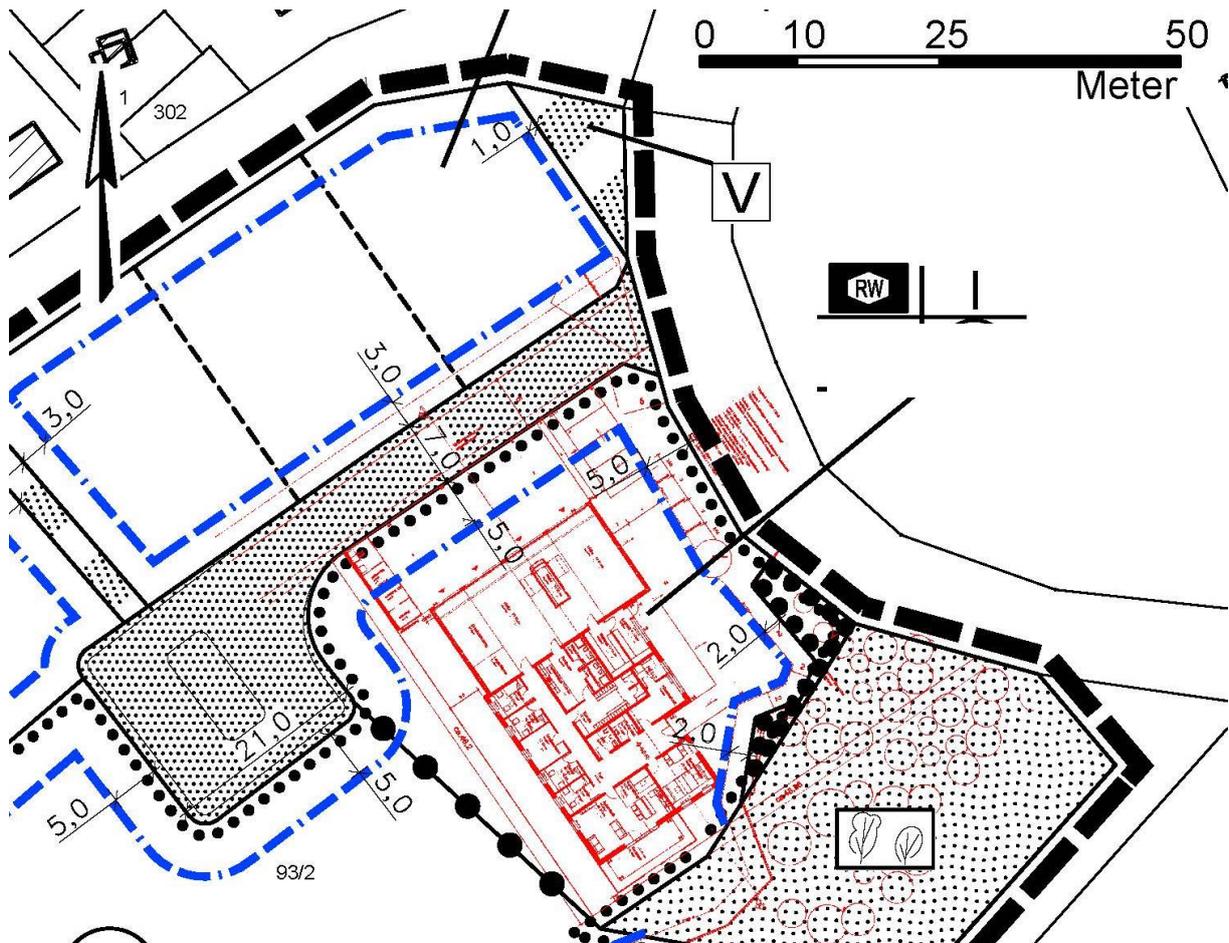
Überlagerung der Fachplanung der Rettungswache mit dem Bebauungsplan
